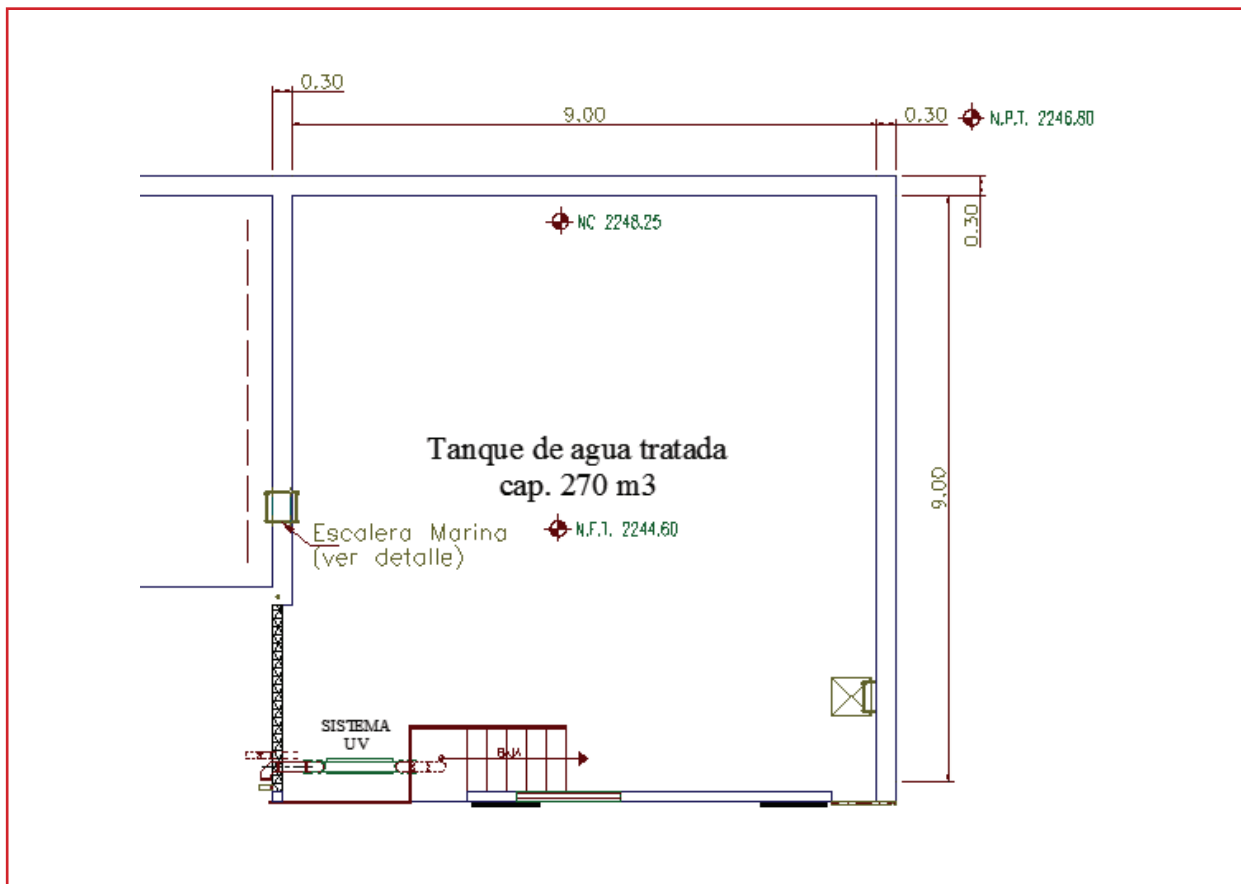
Tanque semienterrado para ejemplo (vista en planta)
